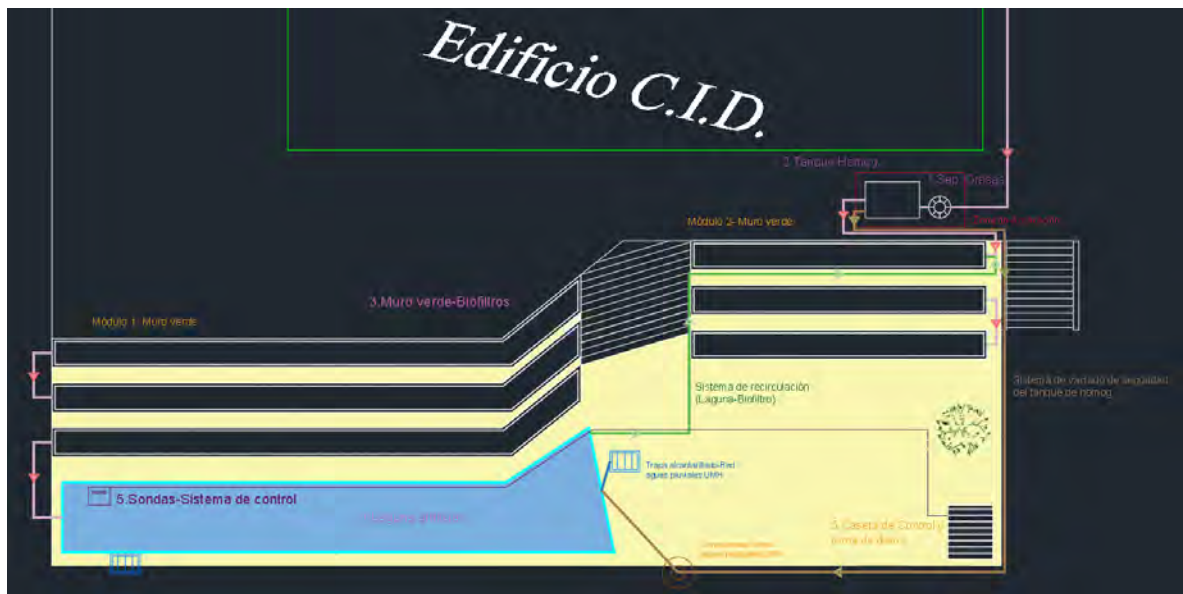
Representación en planta de la infraestructura propuesta. Fuente: Elaboración propia Autocad.
